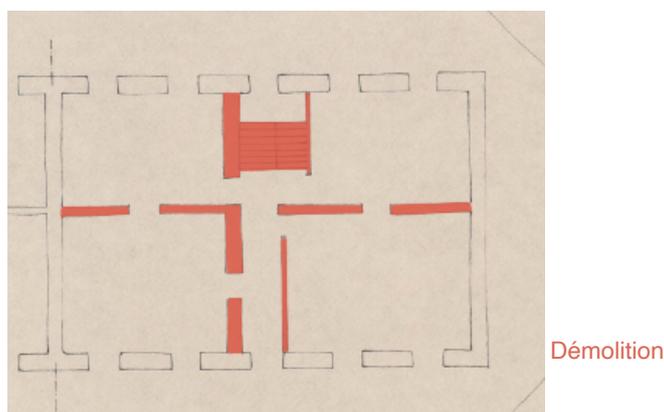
Plan du rez-de-chaussée avant la réhabilitation par le bureau Plannings, mettant en évidence les démolitions subies par la cité. Source : Archives de Verviers.
